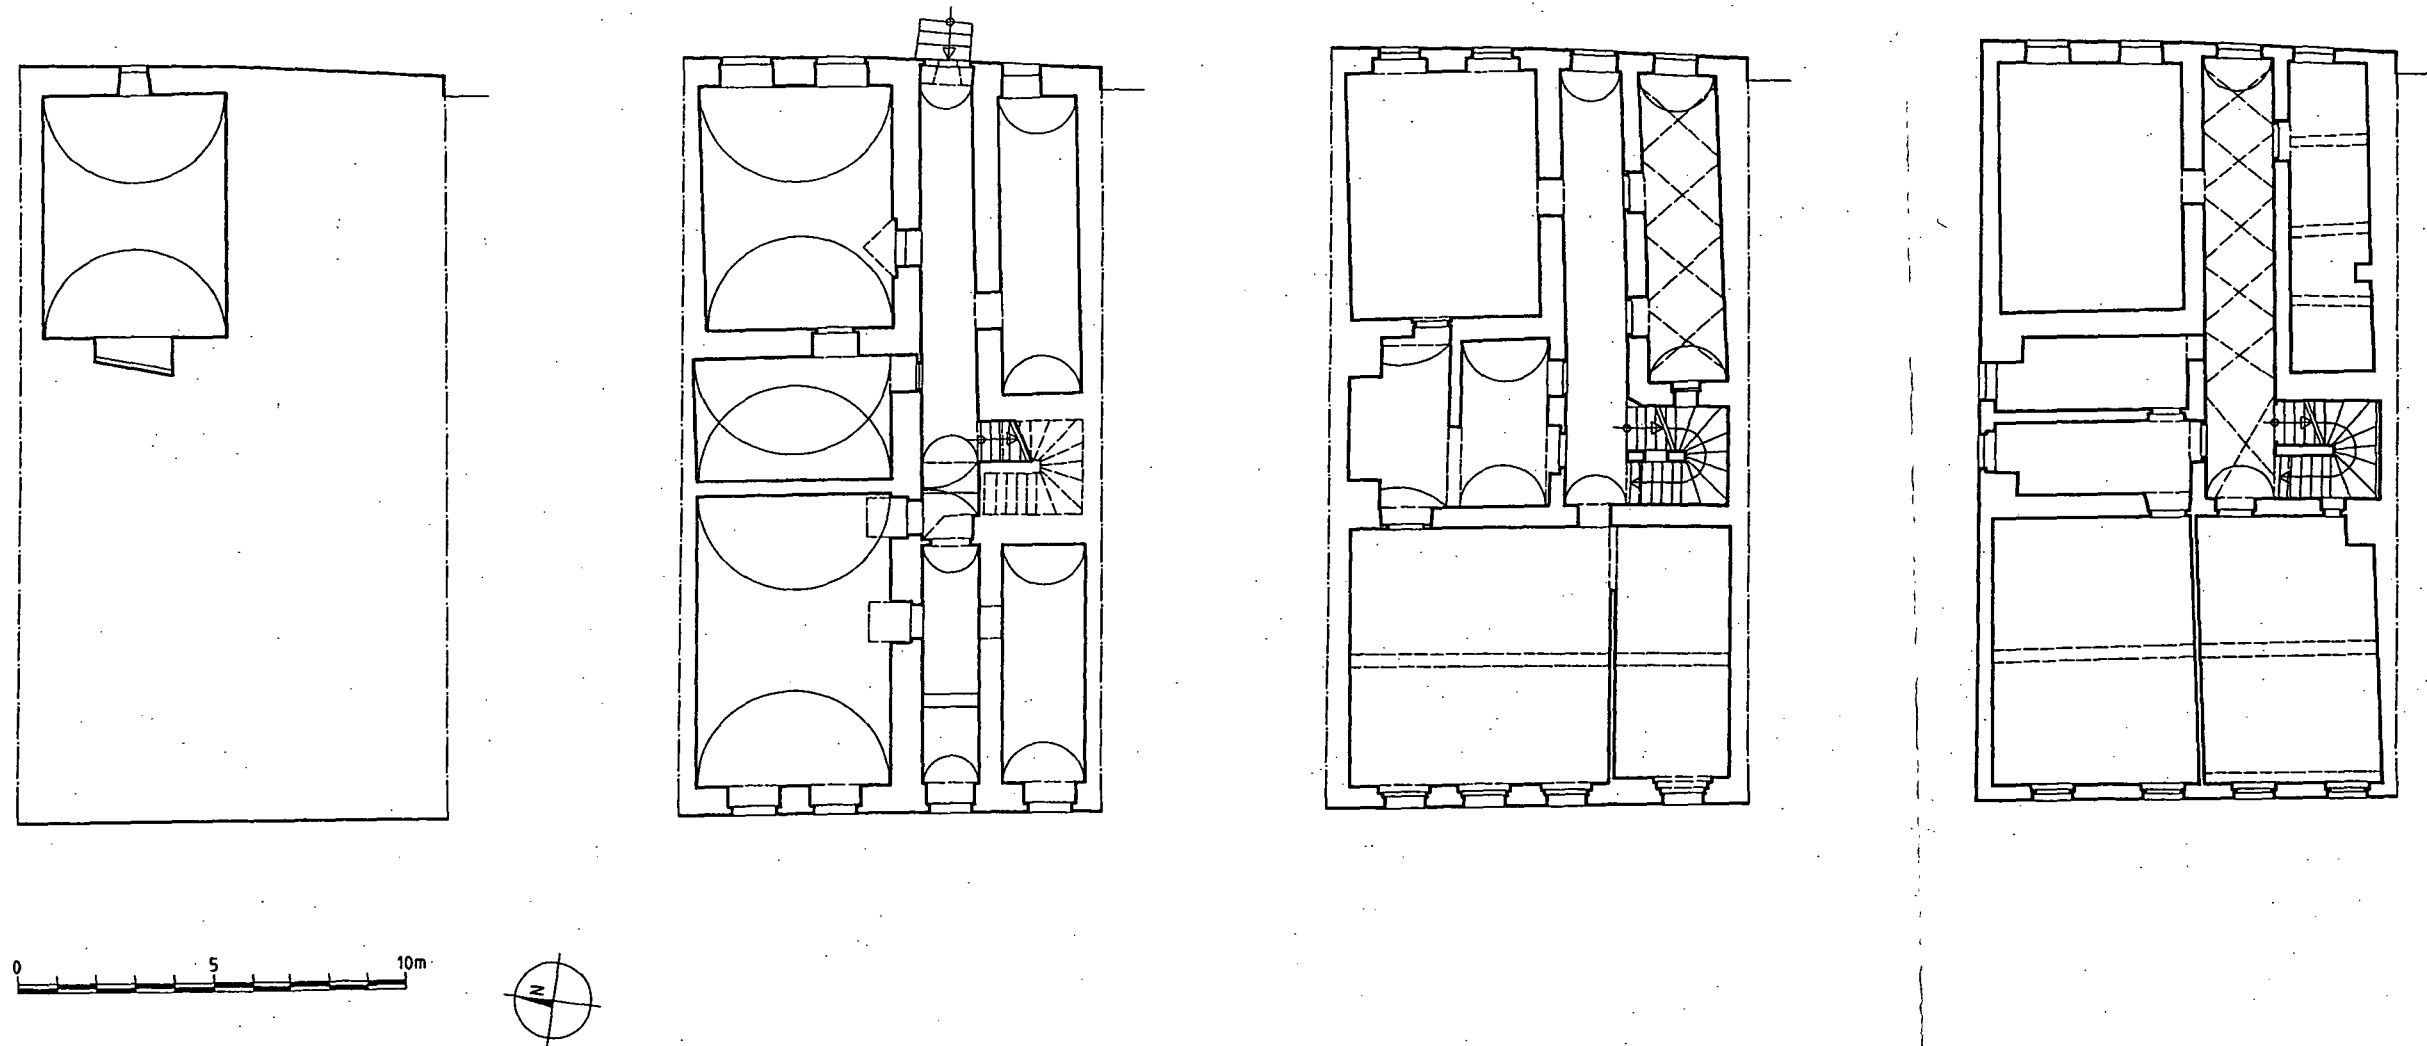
Stadtplatz 9 – Grundrisse Keller, Erdgeschoss, 1. und 2. Obergeschoss (1:200).
